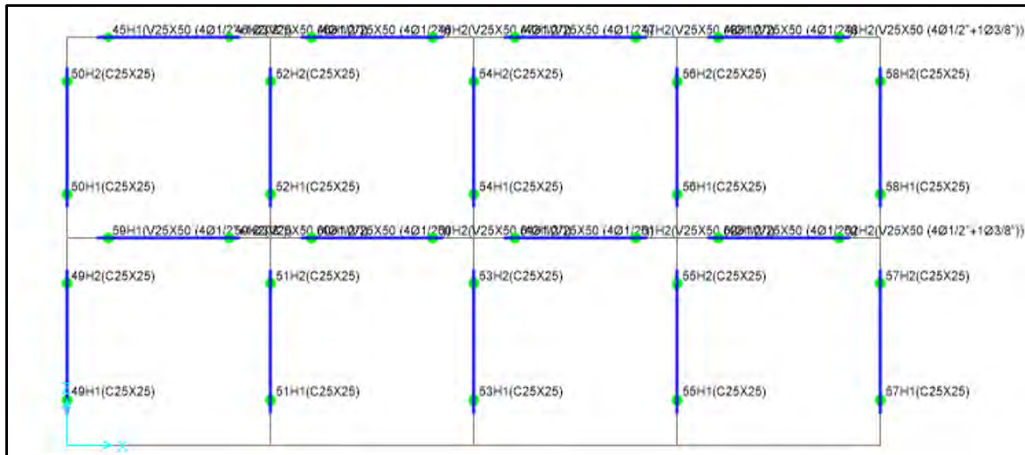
Asignación de rótulas plásticas para columnas y vigas.
